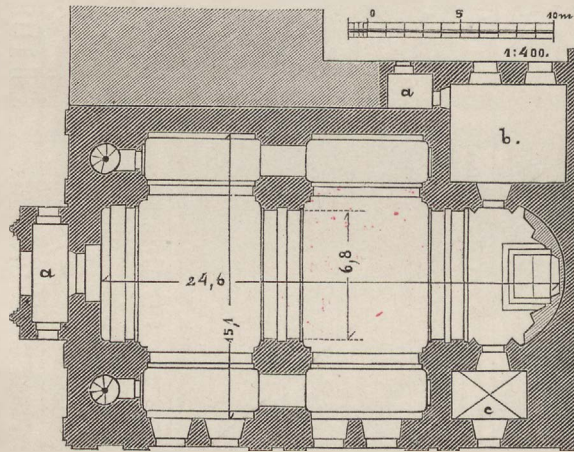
Konitz. Grundriss der Gymnasialkirche, Kirche des ehemaligen Jesuitenklosters.
